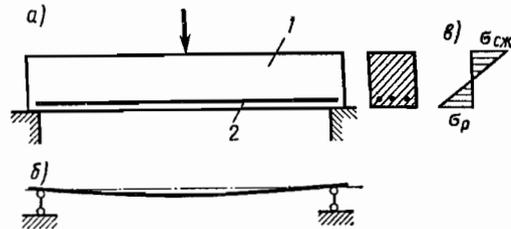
Совместная работа бетона 1 и арматуры 2 в железобетонной балке:
